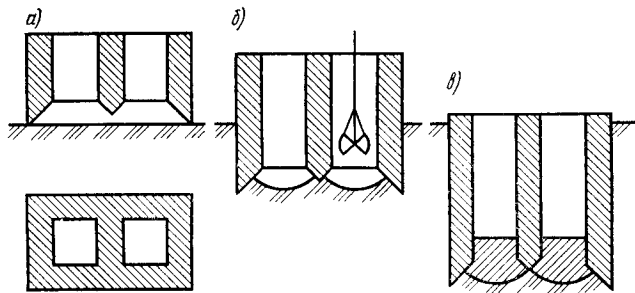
Этапы устройства фундаментов из опускных колодцев:
